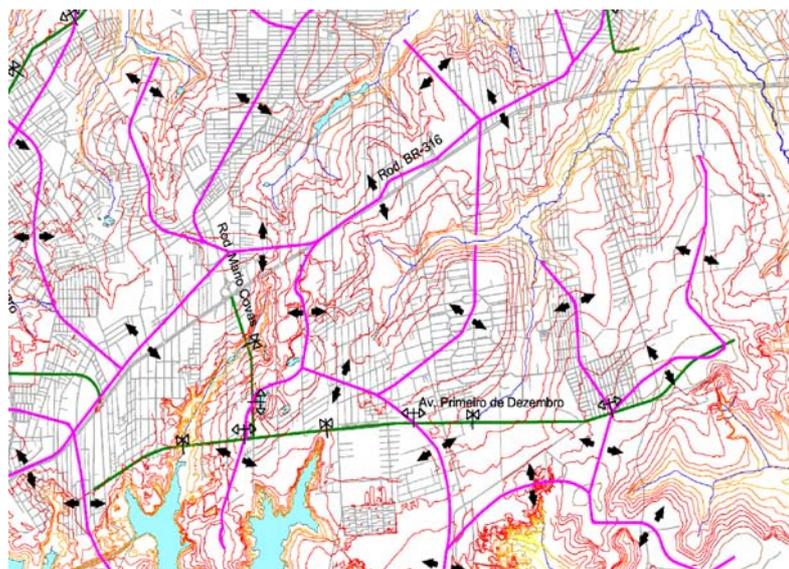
Proposta de Drenagem para Avenida Primeiro de Dezembro
